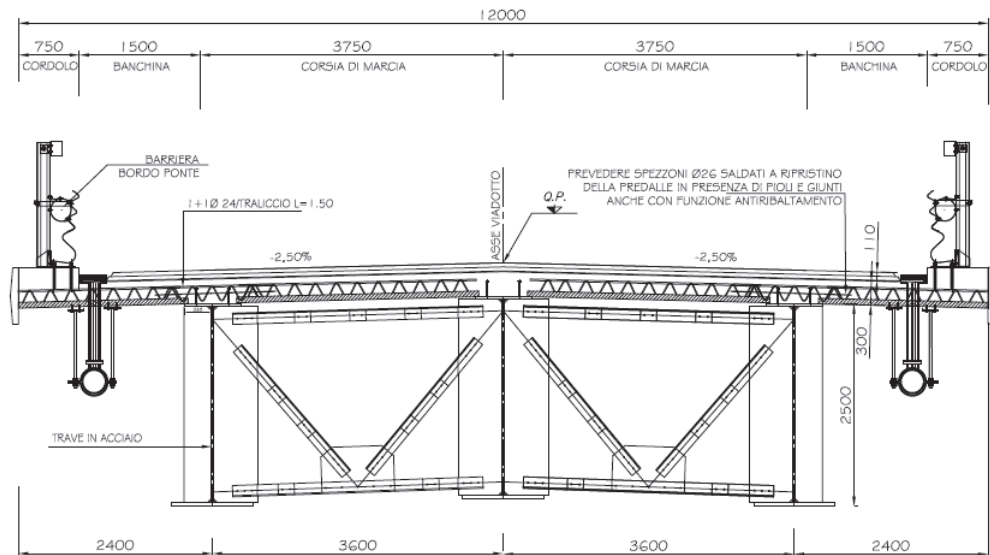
Sezione trasversale dell'impalcato – Sezione corrente trave H=2.50m
